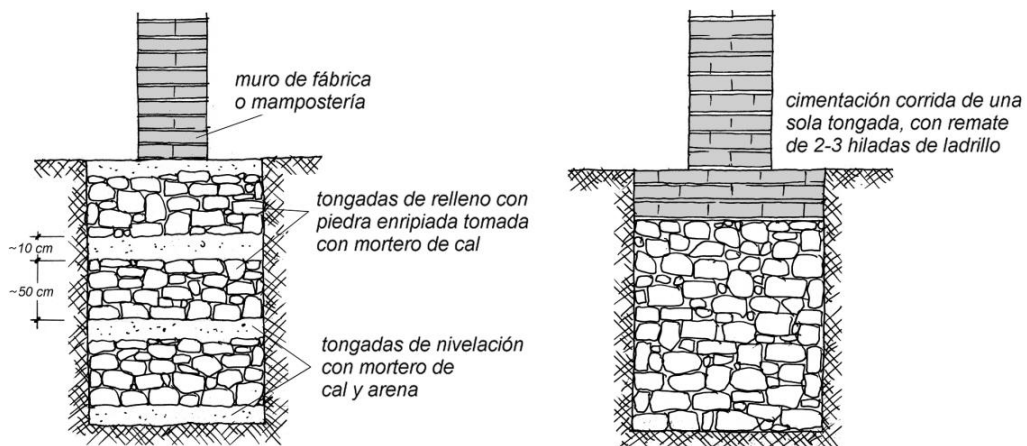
Diferentes sistema de cimentación bajo muro
